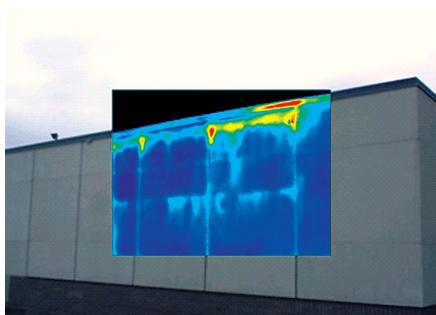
Вода с крыши, не имеющей надлежащего отведения воды, может попасть в бетонные блоки фасада здания.
